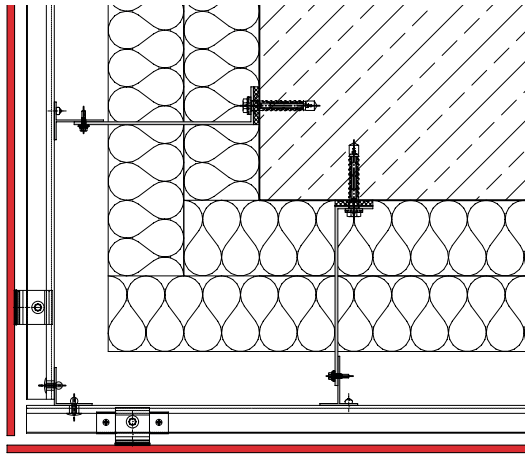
DETAILS VERDECKTE BEFESTIGUNG AUF METALLUNTERKONSTRUKTION
